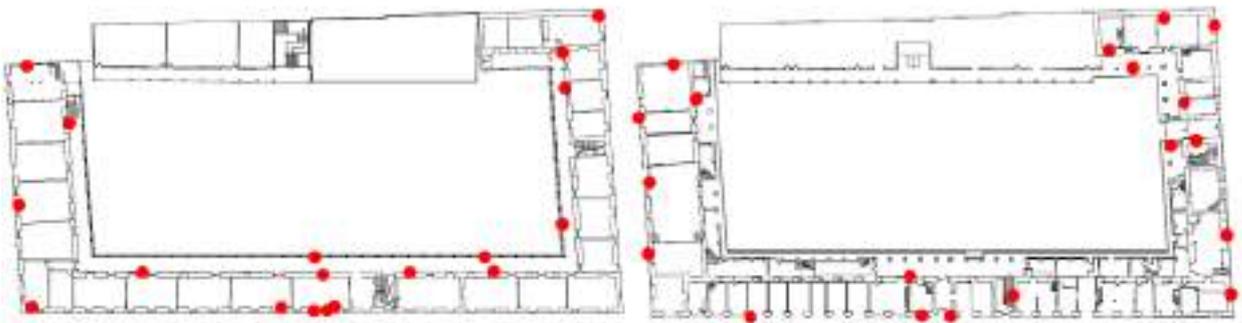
Ubicación de las calas en el espacio arquitectónico en planta baja (izquierda) y planta alta (derecha) (Crédito: Bermeo et al., 2016)
